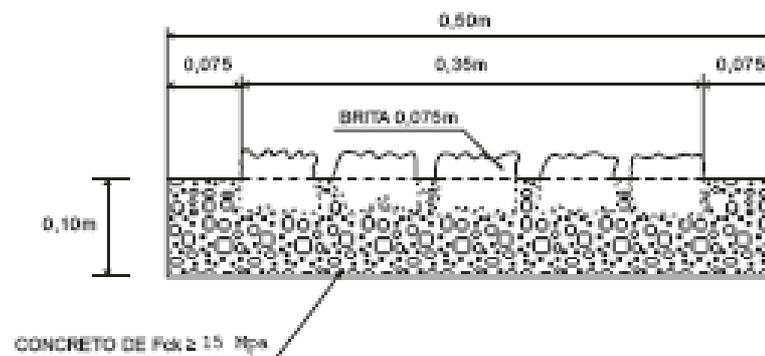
Dissipador contínuo com pedras assentadas em concreto
